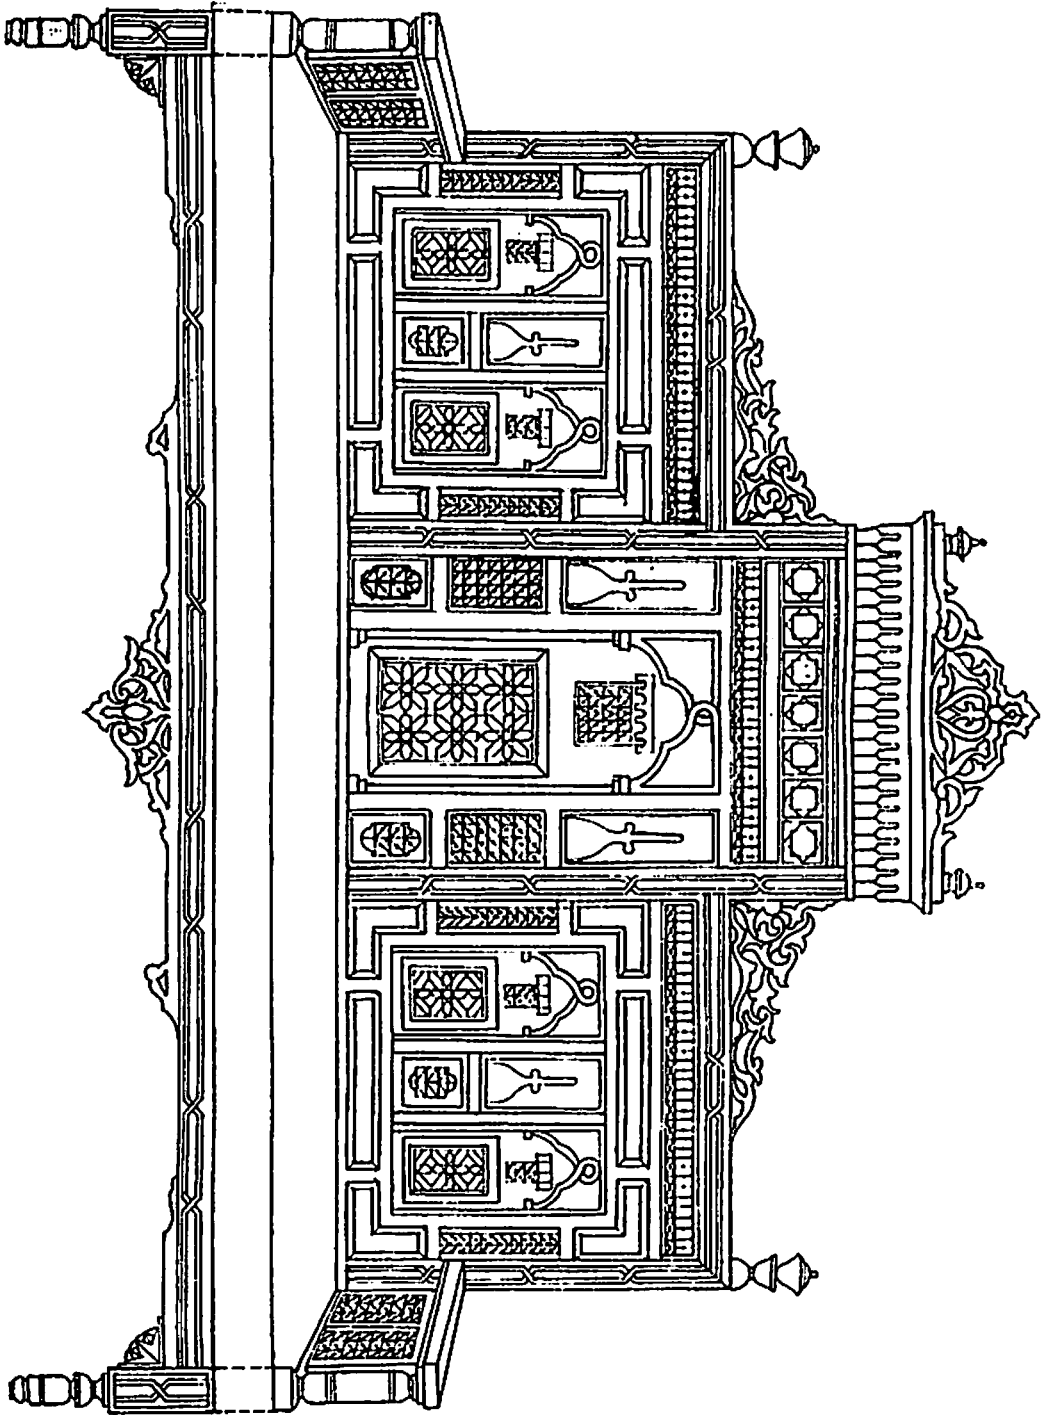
مسقط أفقي لسقف خشبي لمحل سياحي بالهرم (تصميم المؤلف)
